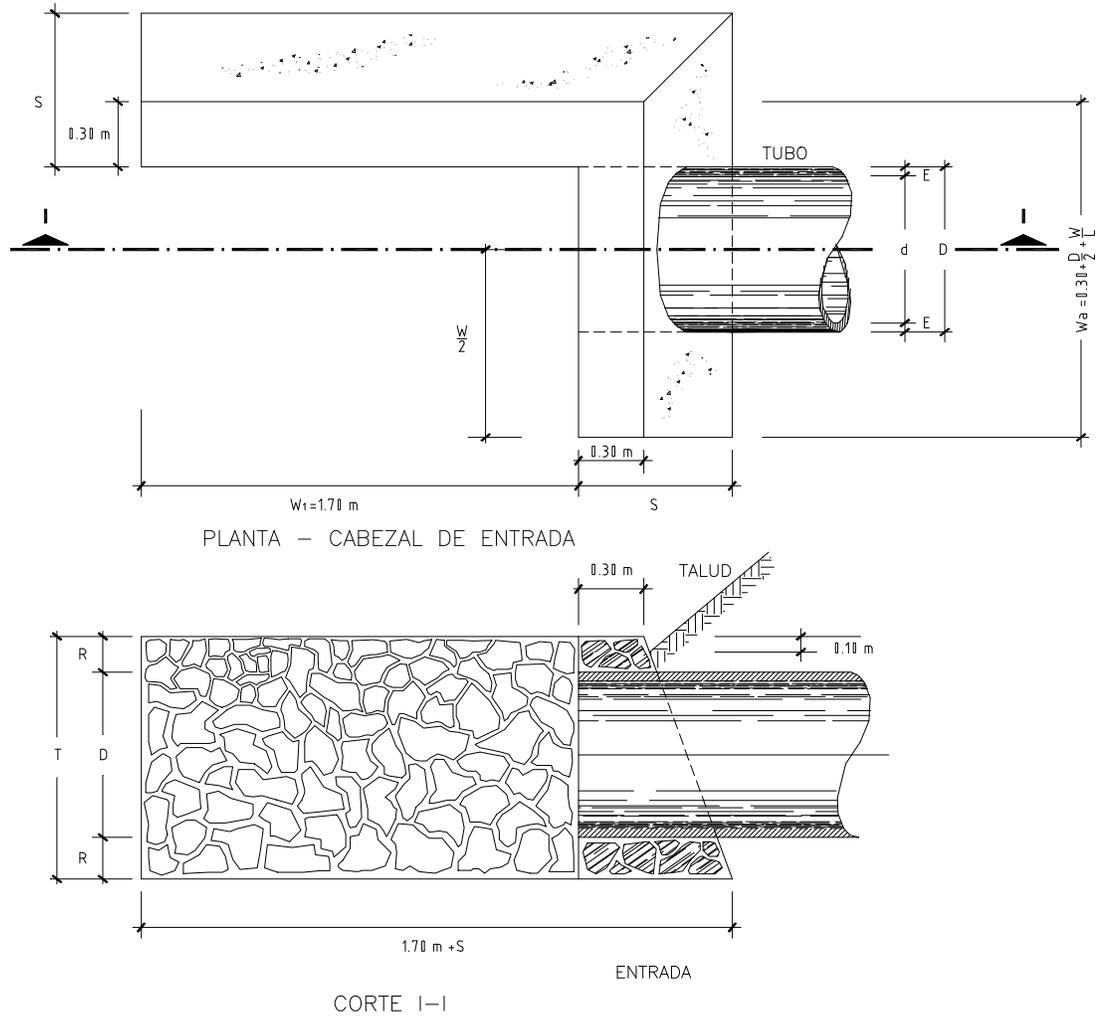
DETALLE DE CABEZAL TIPO "C" EN PLANTA Y PERFIL.
